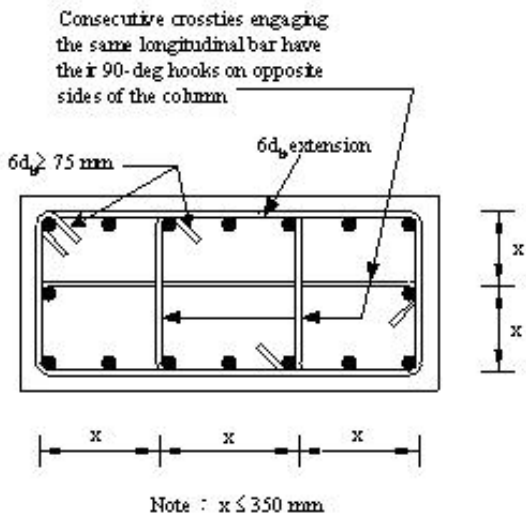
鋼筋混凝土耐震柱的棋向鋼筋配置圖
